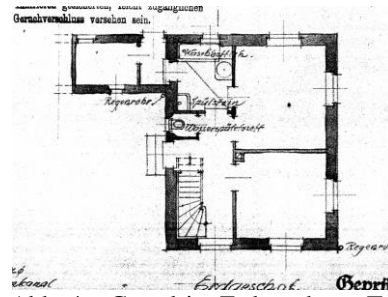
Grundriss Erdgeschoss, Typ A_{II}
